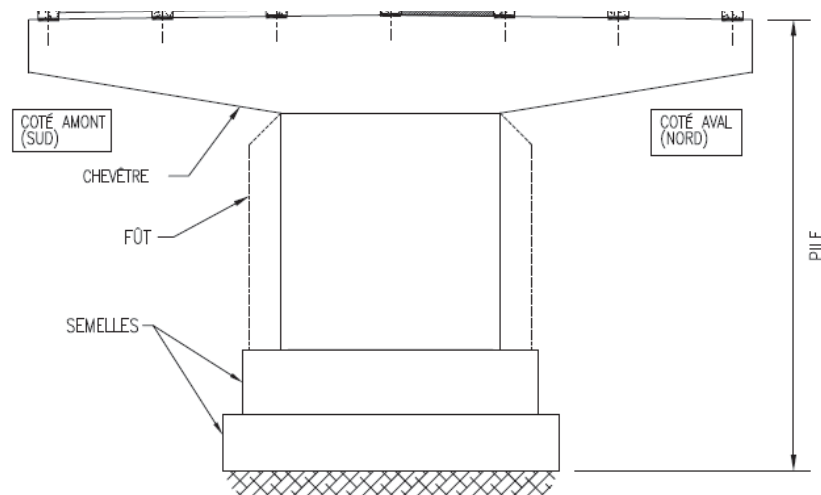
Piles – Section 7B (source : plans nomenclature PJCCI)
